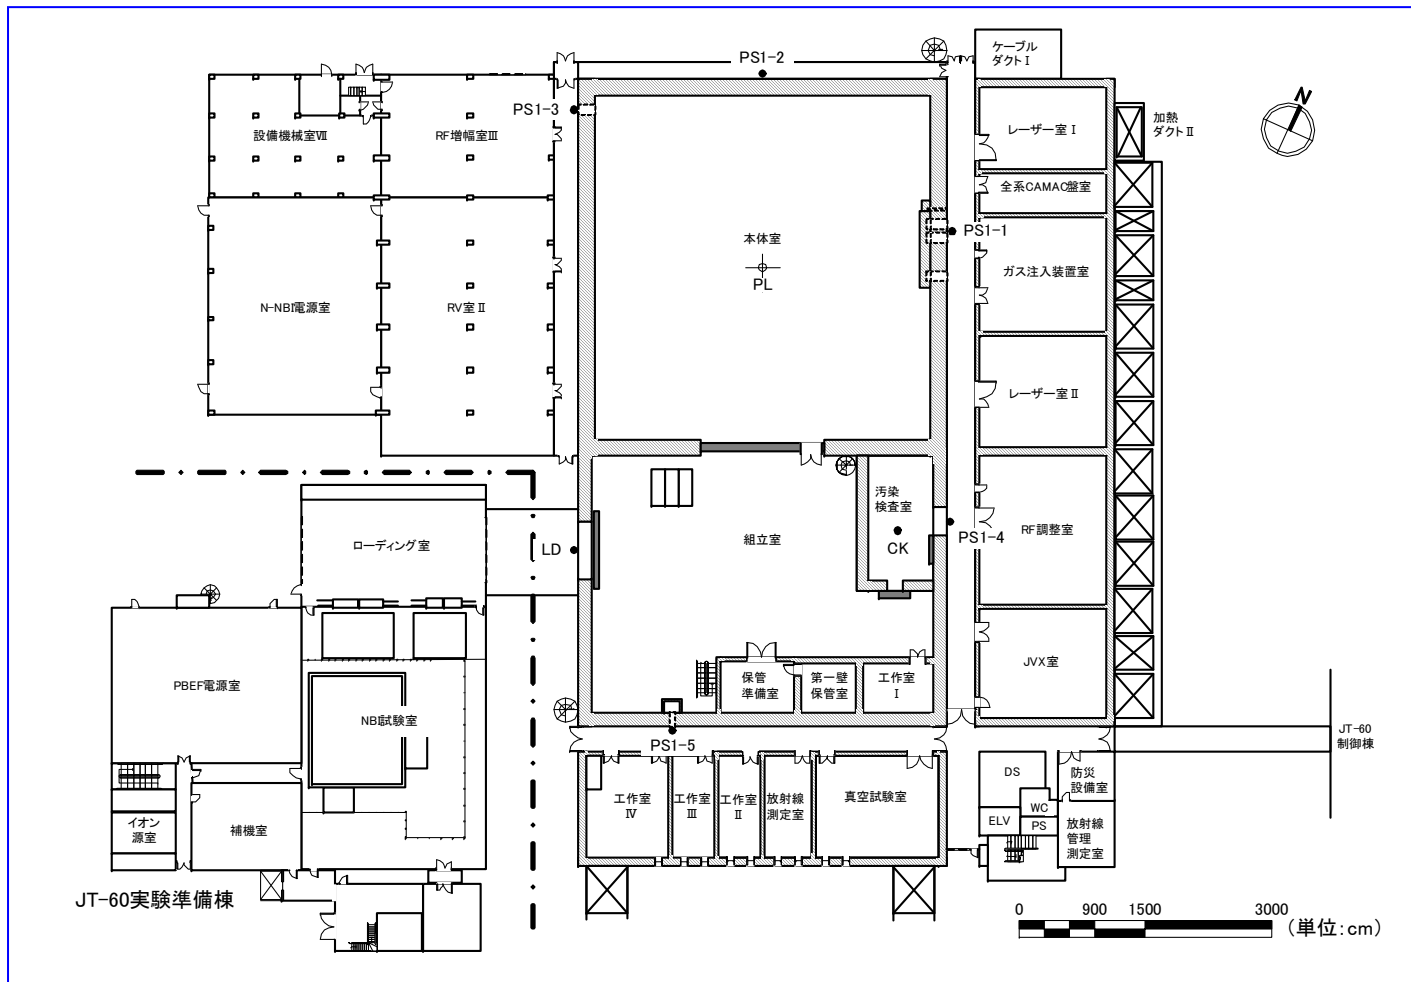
1. 5. 1 JT-60実験棟1階平面図 (単位: cm) (改修前)
